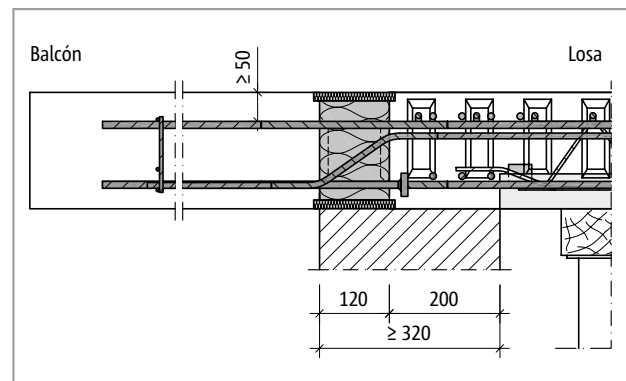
Schöck Isokorb® XT tipo C: Placa prefabricada con apoyo periférico con muro aislante (sección XT tipo C-R-CV50, vista XT tipo C-L-CV35)
